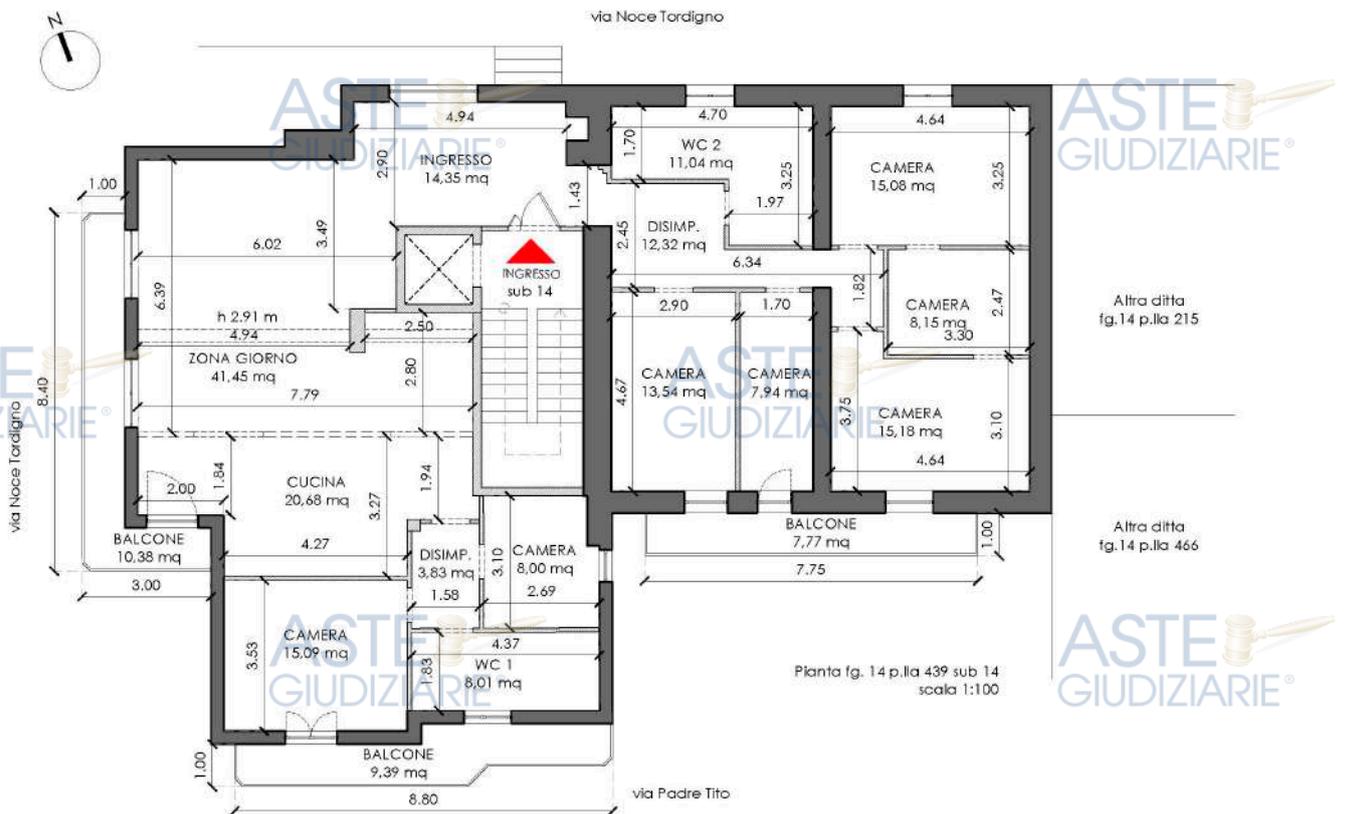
Rilievo Abitazione in corso di costruzione Lotto Tre Stato di fatto \_ pianta piano secondo (Allegato 6E)
